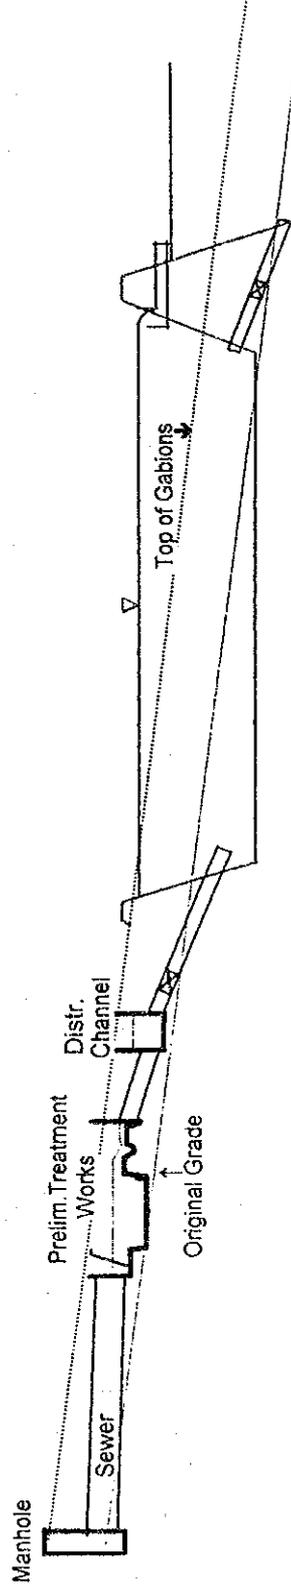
Plan de los Trabajos de Entrada y Cañerías
